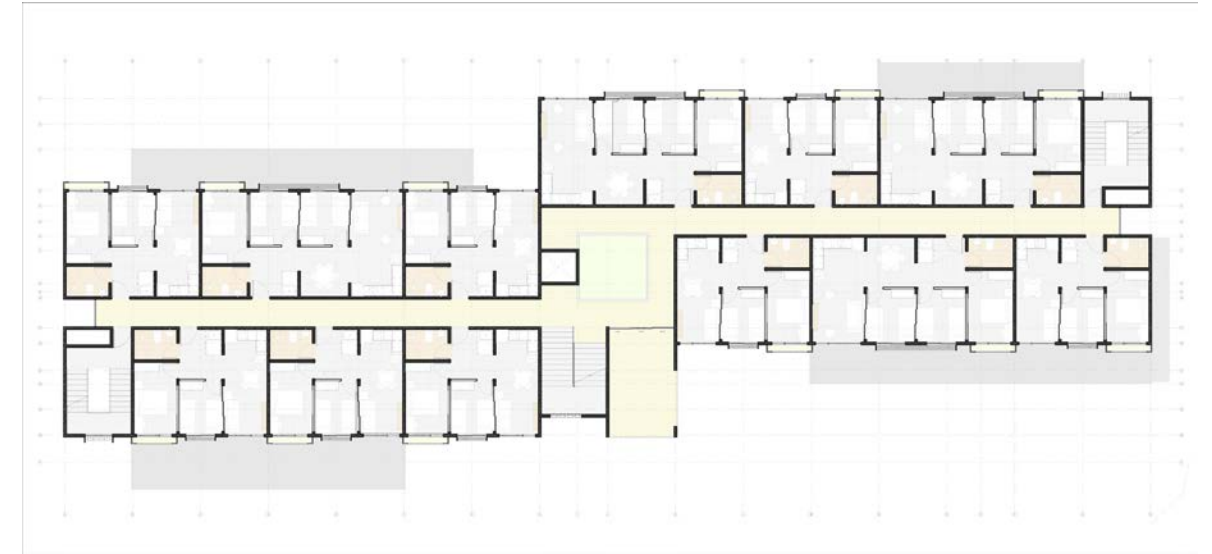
Planta de distribución arquitectónica tipología de vivienda flexible, nivel 2 y 4.
